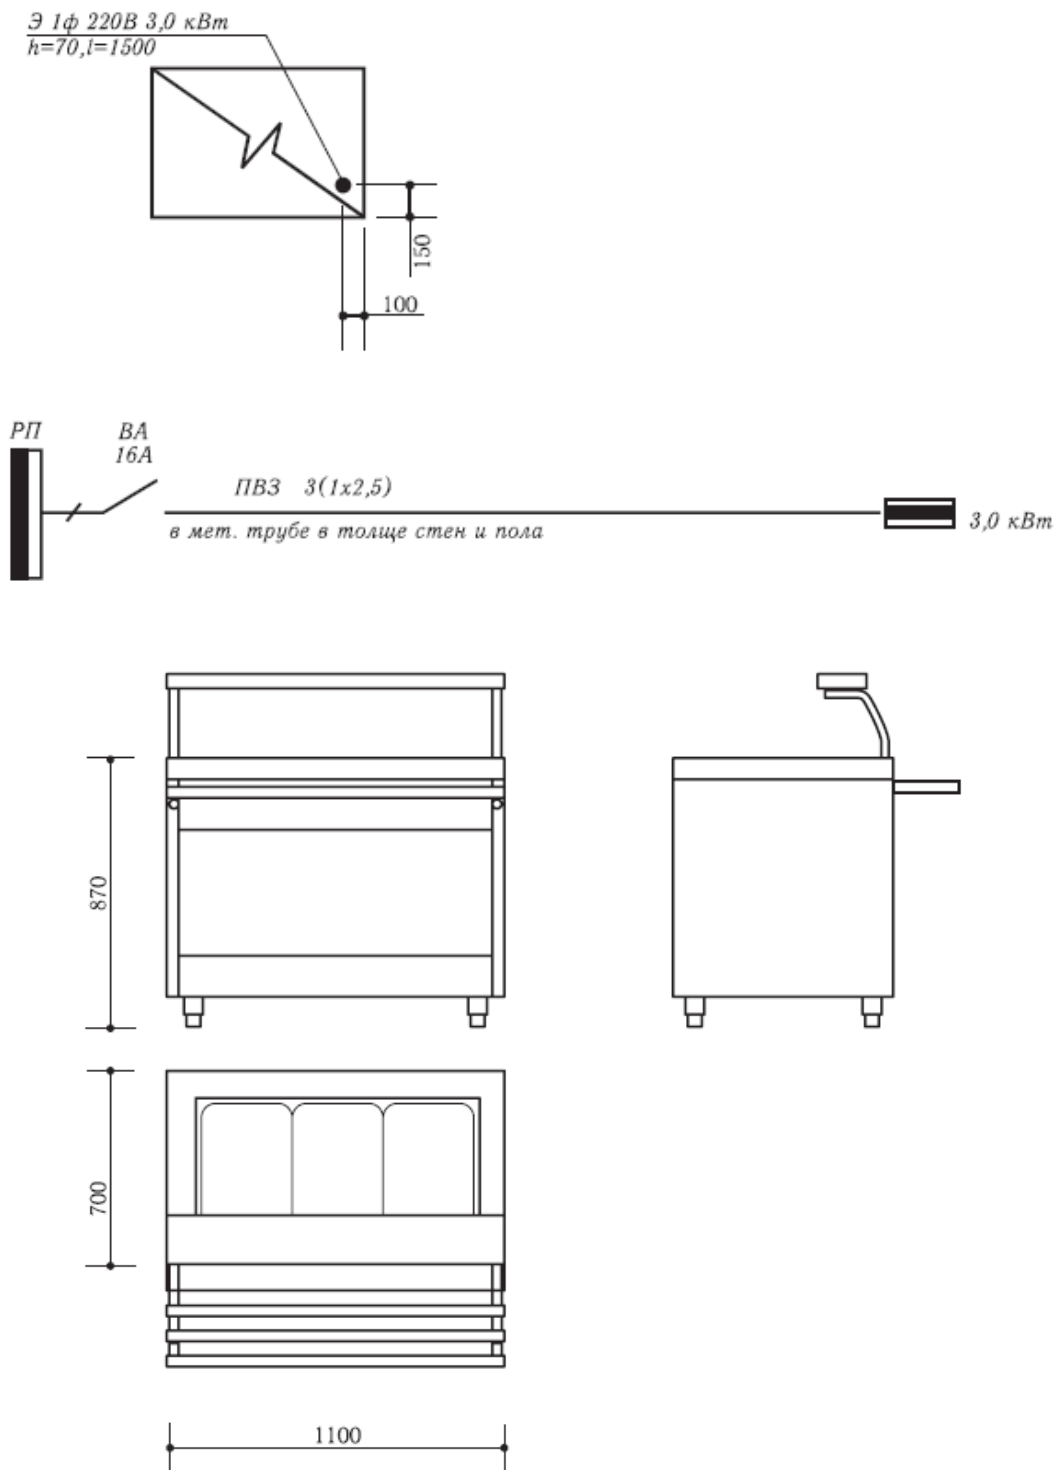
Габаритные размеры и схема подключения прилавка нейтрального RADA «МАСТЕР 2 ПН-11/7Н»
